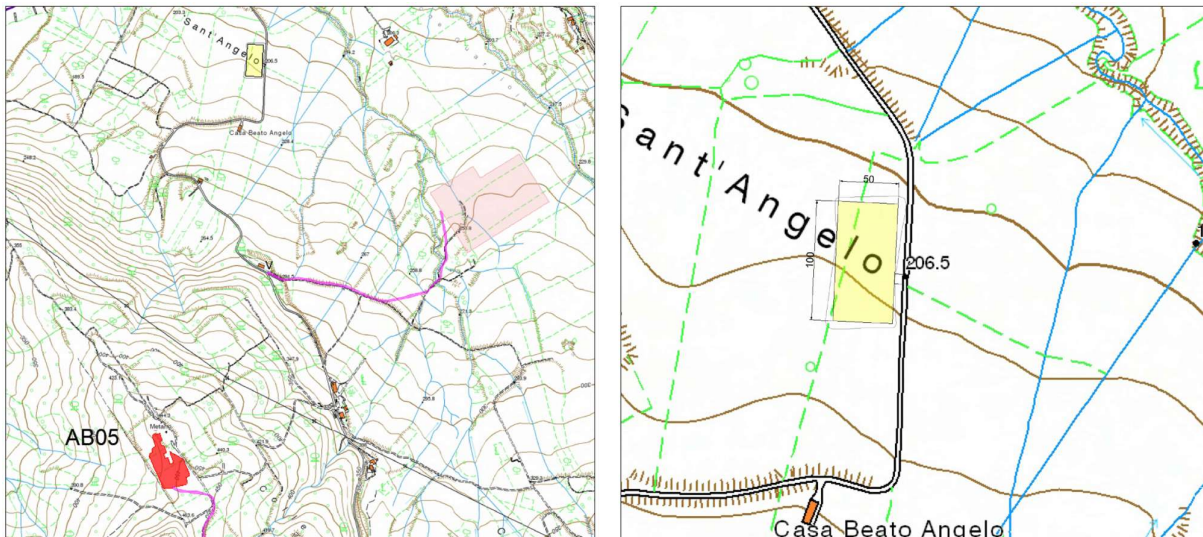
Posizione e dimensione area di cantiere Parco Eolico Abruzzo
